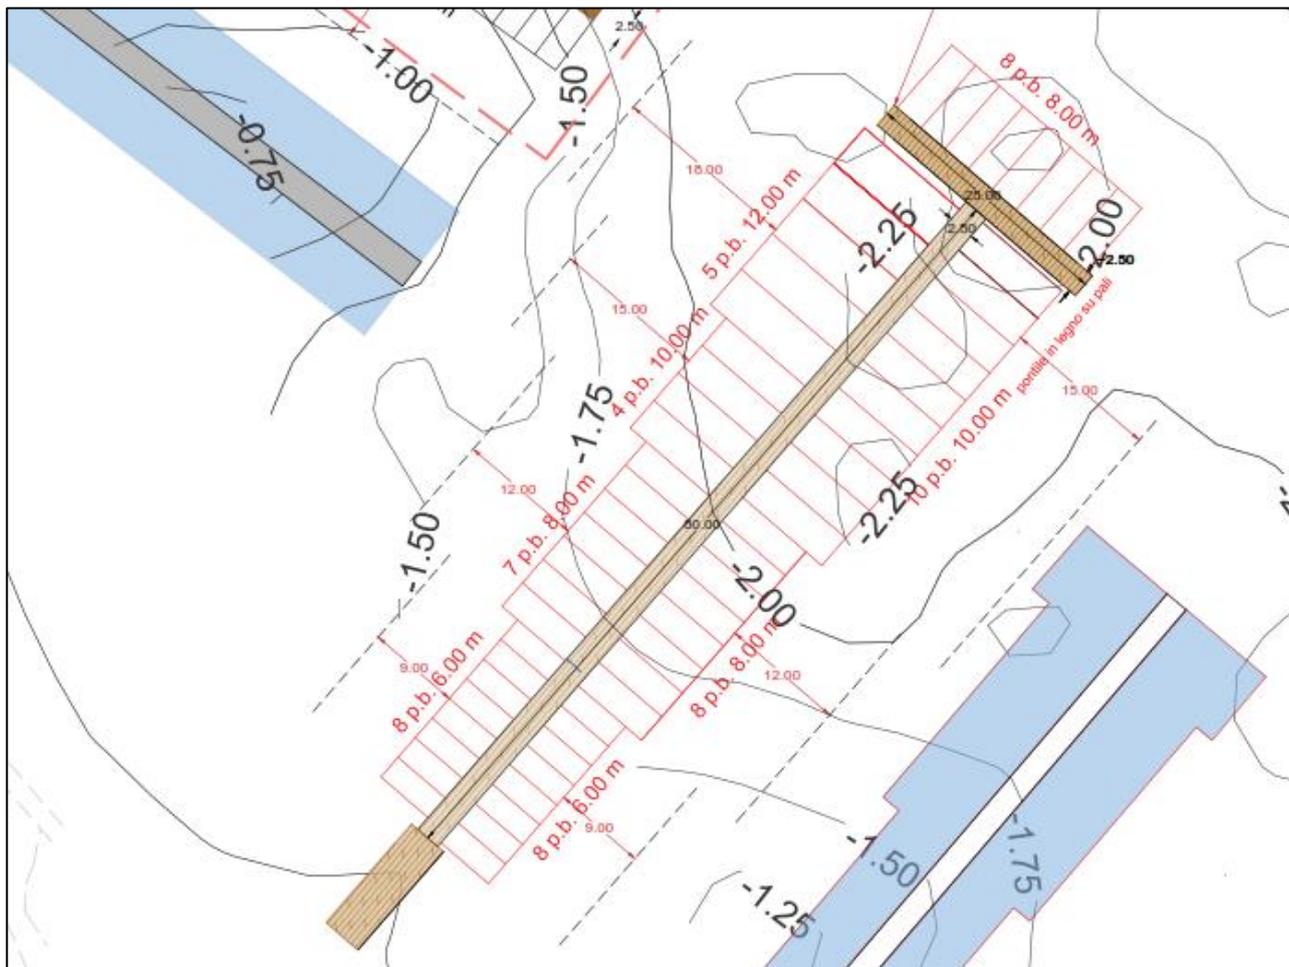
Stralcio planimetrico nuova struttura di ormeggio
